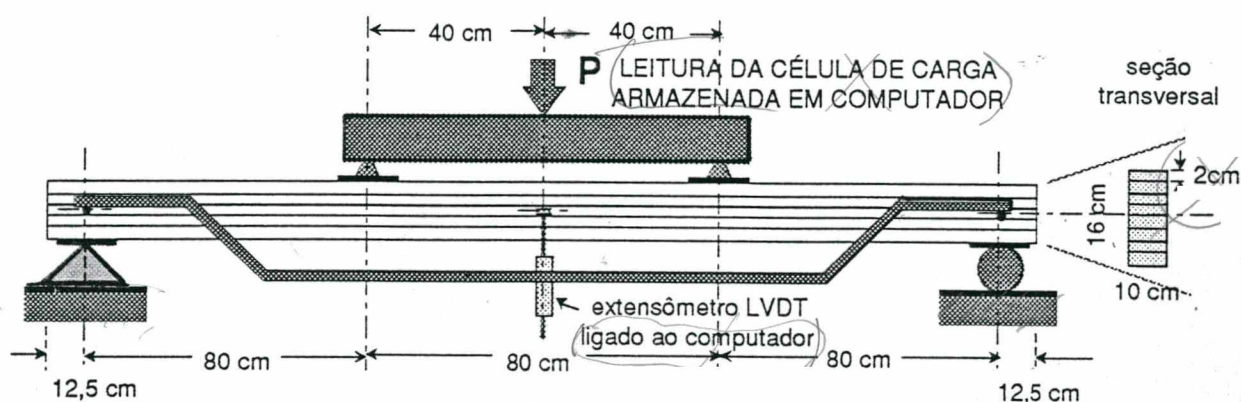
Esquema de ensaio de flexão simples das vigas.
